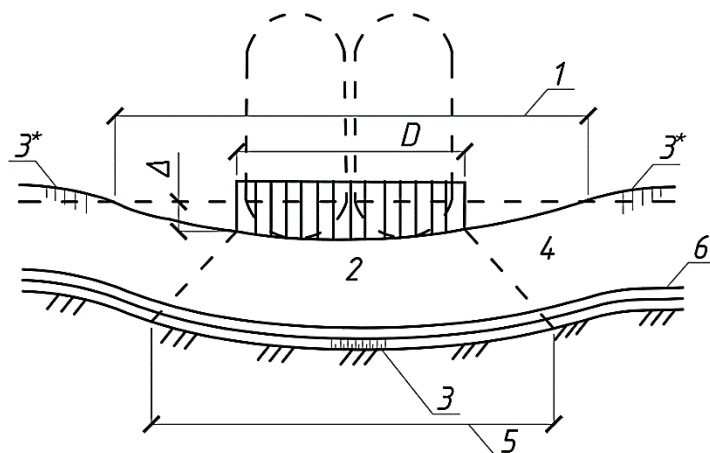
Влияние различных методов армирования покрытия на разрушение нежестких дорожных одежд под воздействием подвижной нагрузки:
